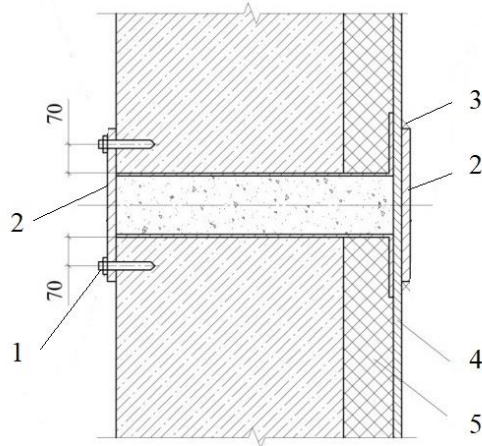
Узел заделки проходок в помещениях ЗКД: 1 – анкер; 2 – стальной лист; 3 – сварной шов; 4 – облицовка; 5 – теплоизоляция
